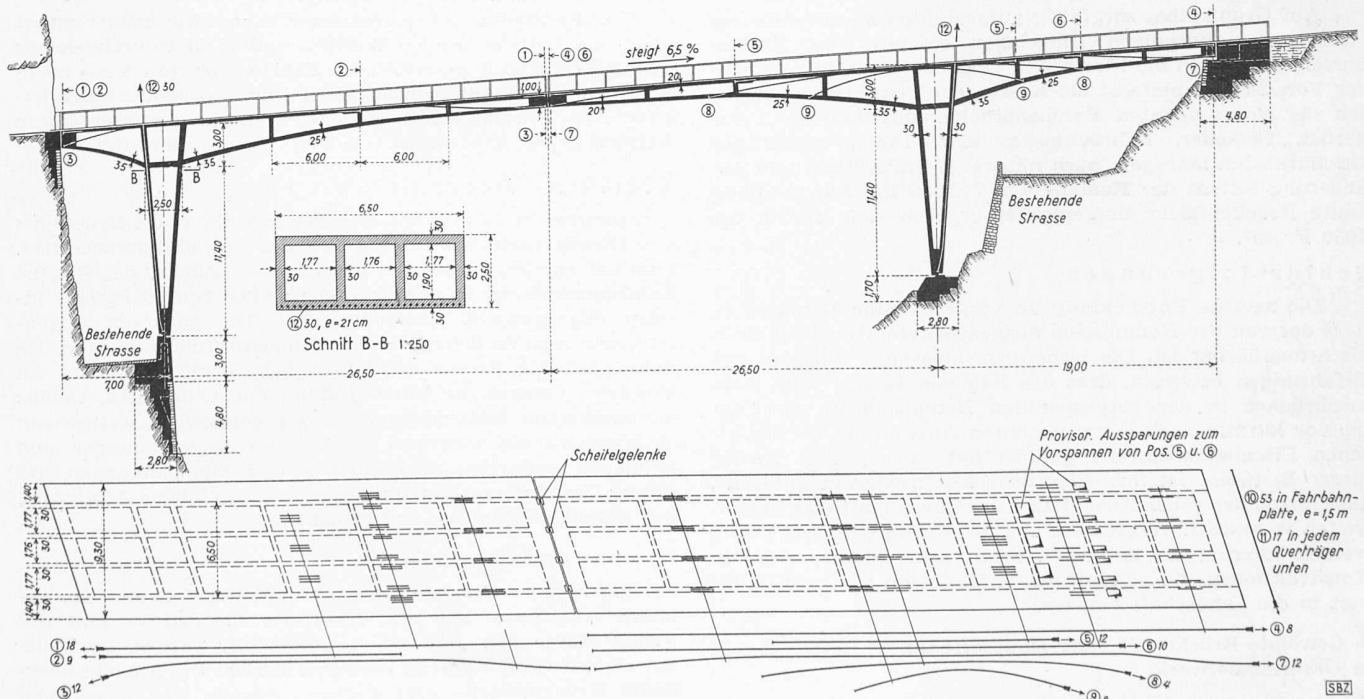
Rahmenbrücke in vorgespanntem Beton, Längsschnitt und Grundriss 1:500. Spezialbeton P. 330 mit 0,6% Frioplast, Im Kreis die Positionsnummer, neben dem Kreis die Anzahl der Vorspannkabel System BBRV aus Stahldrähten mit min. 150 kg/mm² Zugfestigkeit, Vorspannkraft 80 t pro Kabel
